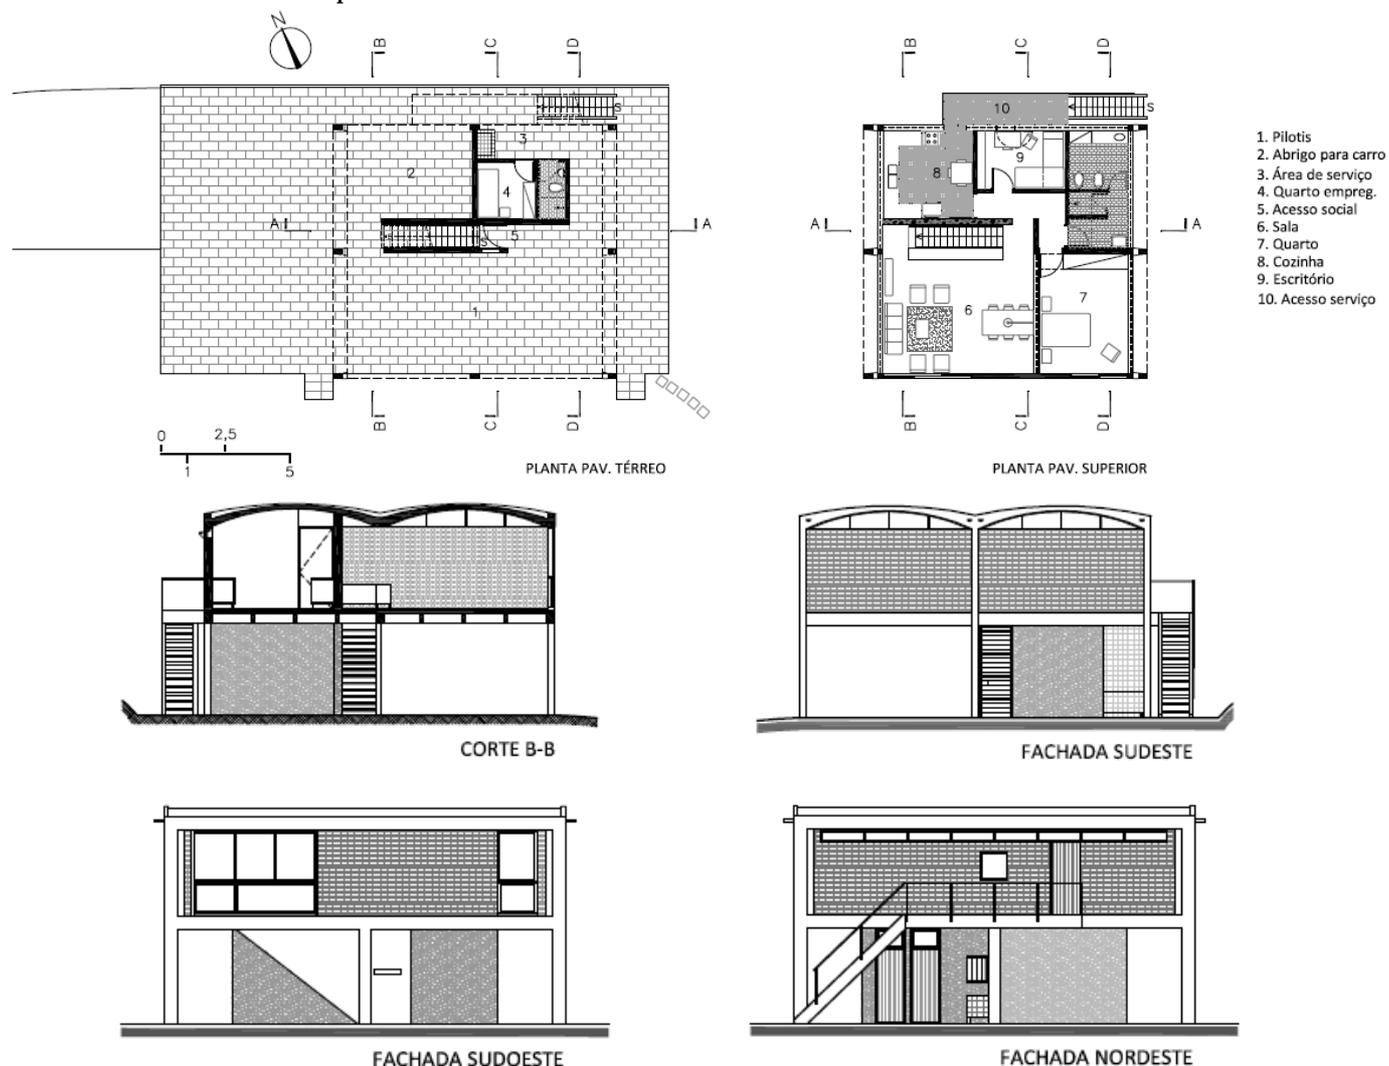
Plantas, fachadas e cortes da Casa de final de semana do arquiteto (1959)
